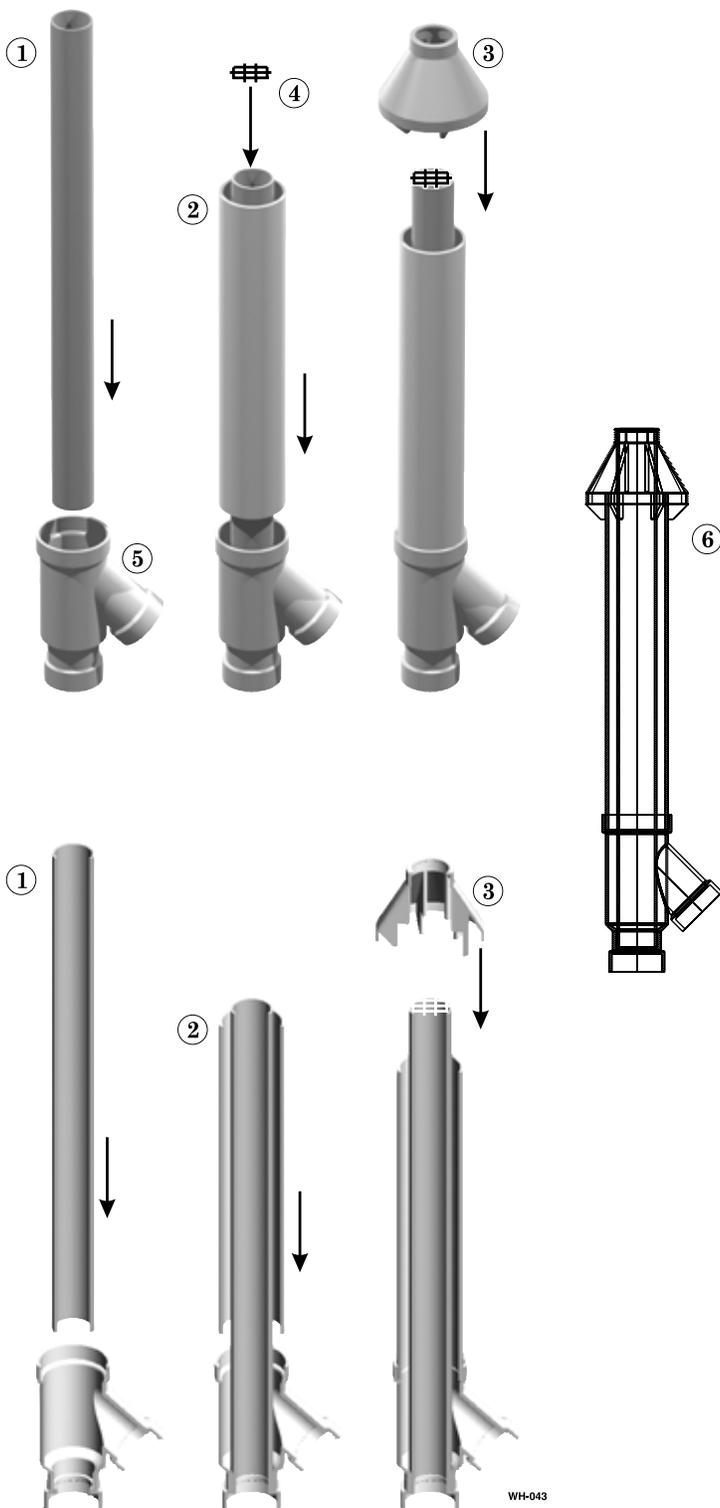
Entrée d'air dans mur latéral (terminaison) pour événement direct : événement vertical/air mural
